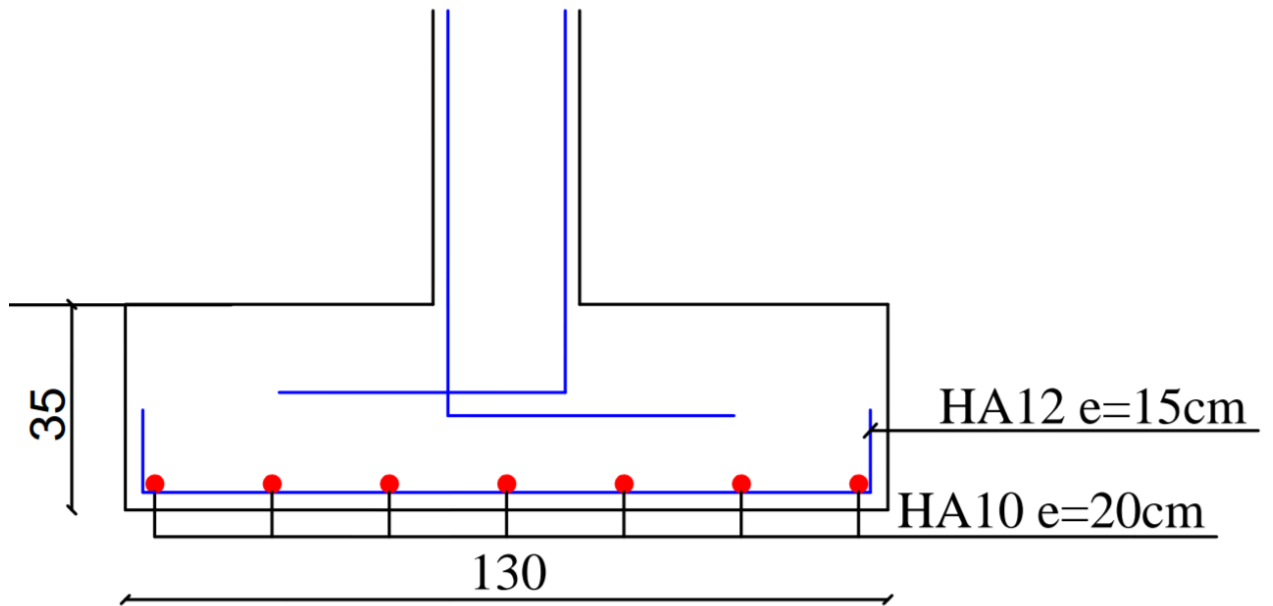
Ferrailage de semelle filant sous voile 1
